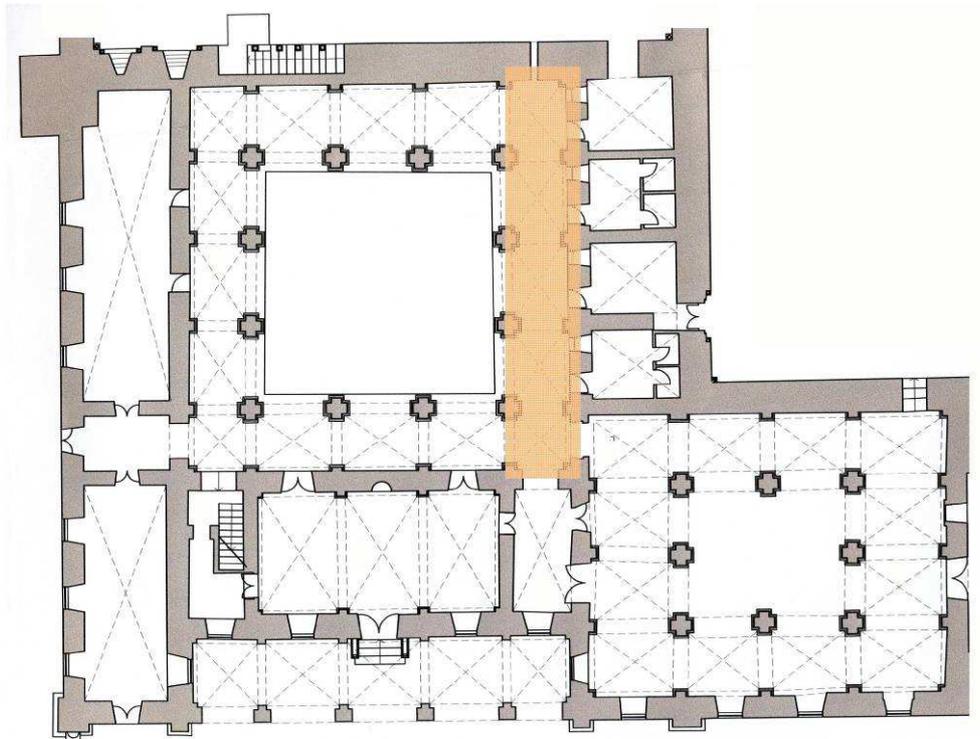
Localização da galeria Sul na planta do piso térreo do levantamento de 2003.
